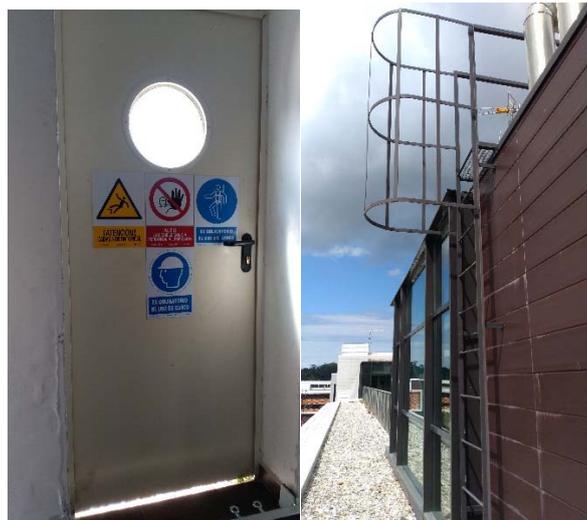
Puerta de acceso restringido a cubierta y escalera de acceso a nivel superior cubierta
